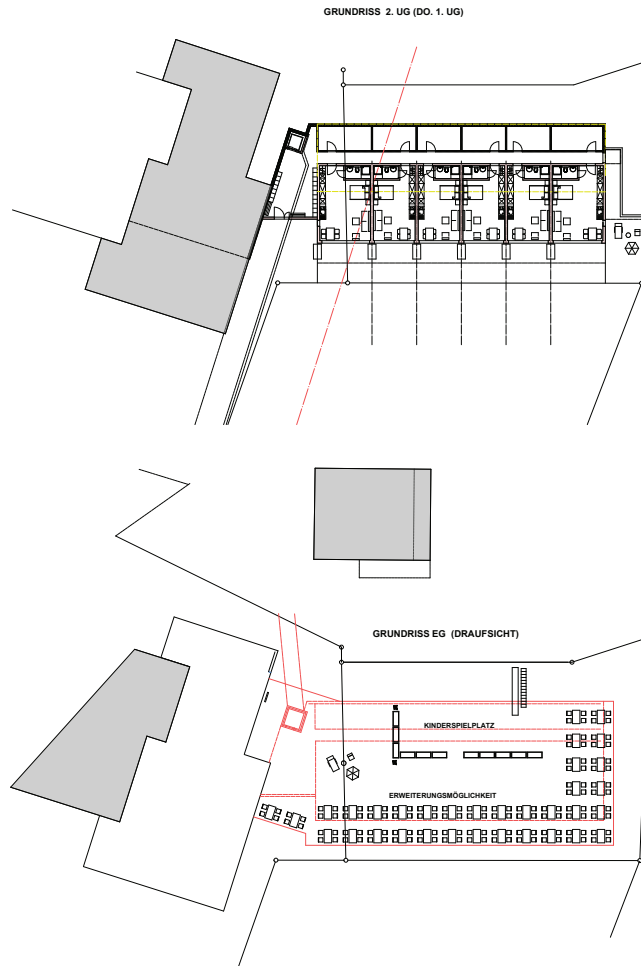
Der Anbau zur Erweiterung der Aussenterrasse des Hotels und Restaurants. Im Untergeschoss sind kleine Studio-Apartments vorgesehen (Quelle: Gottfried Schmid, August 2025)
